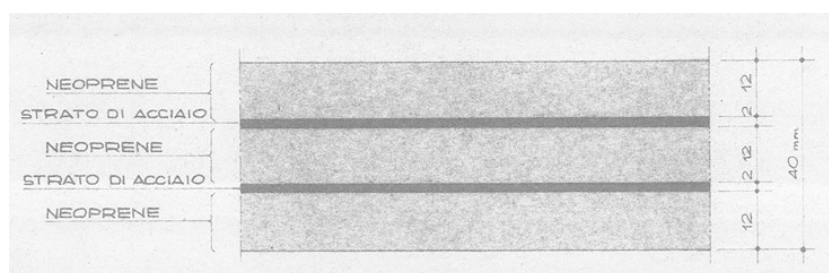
Sezione dispositivo d'appoggio tipo
